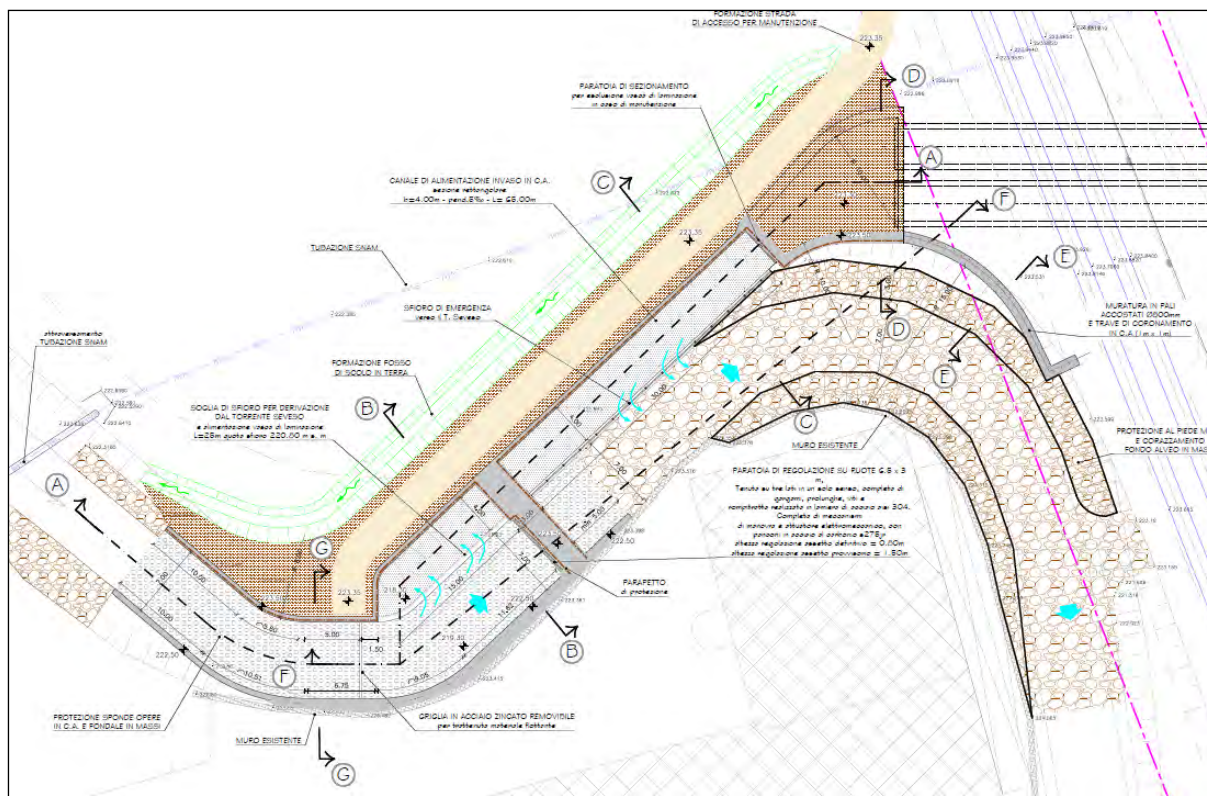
Planimetria di progetto dell'opera di presa dal T. Seveso
